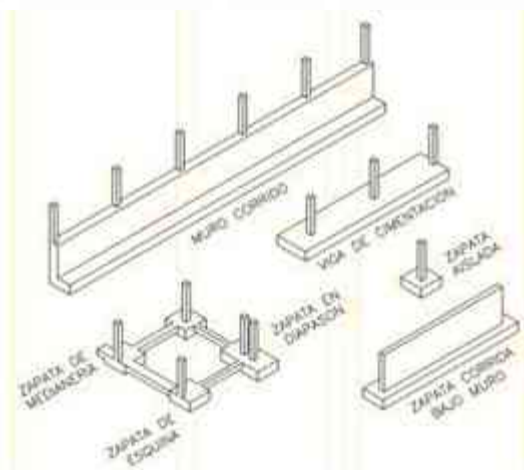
, tipos de zapatas , imagen disponible en :<http://img.youtube.com/vi/FimPDvHUSH0/0.jpg> , actualizada el 22 de junio 2014
